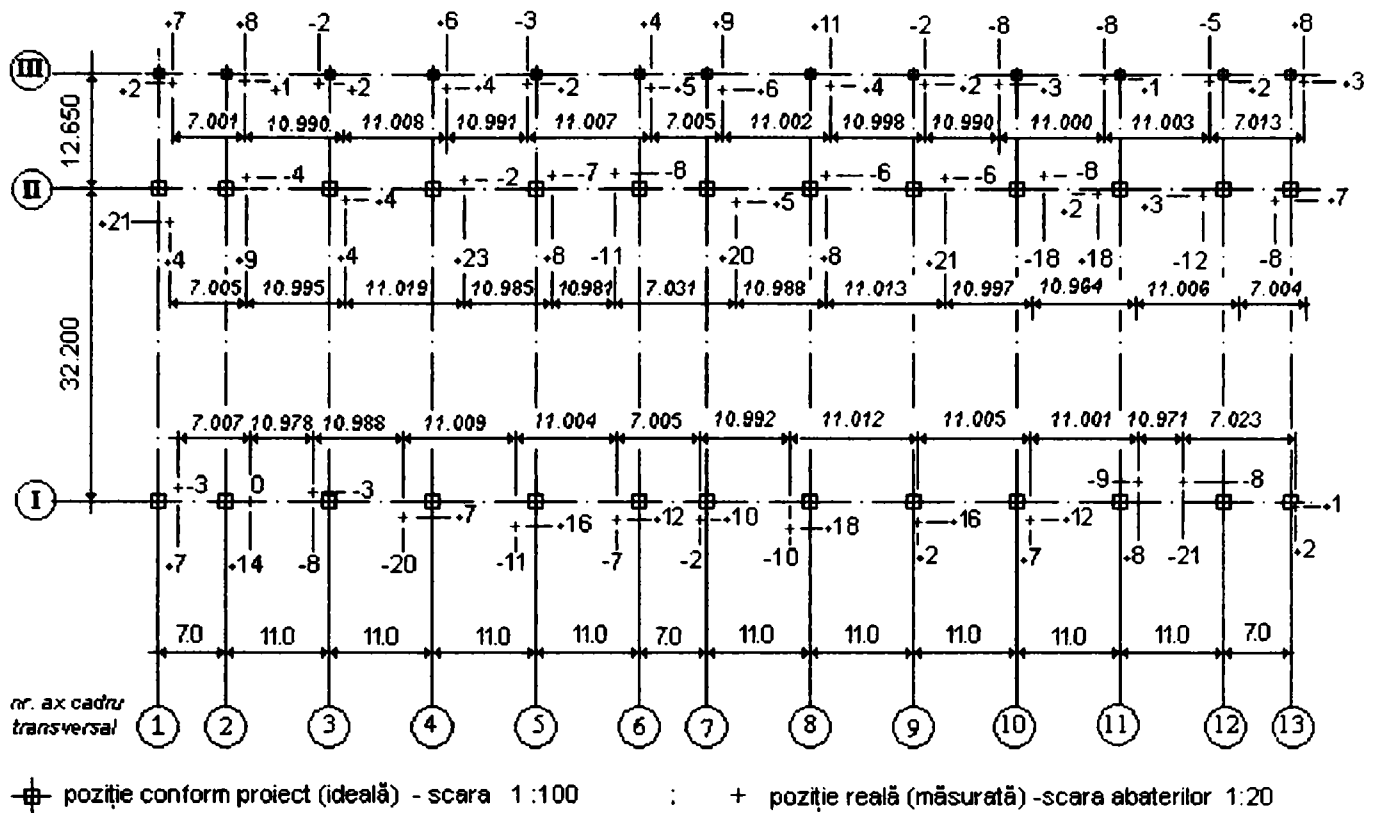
Schema pozițiilor stâlpilor cadrelor transversale, în secțiunea orizontală situată la nivelul 2 de măsurare
